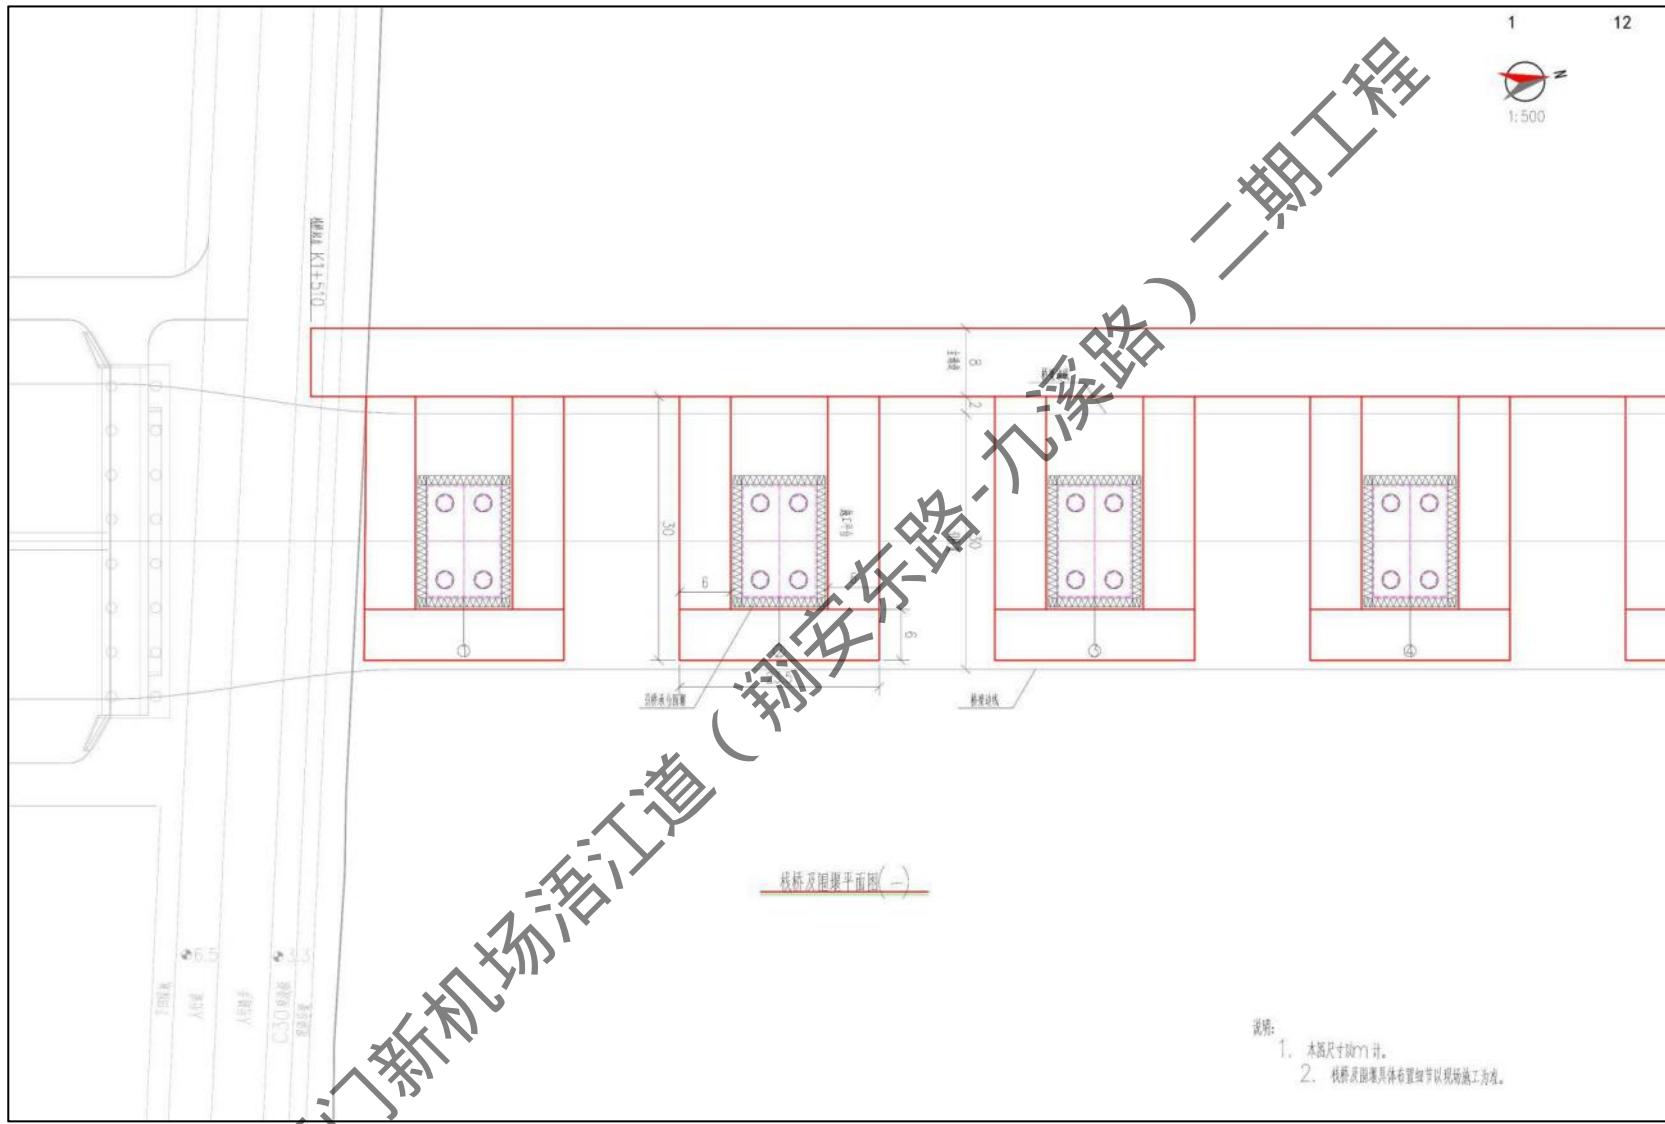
施工栈桥及围堰平面布置图 (一)
